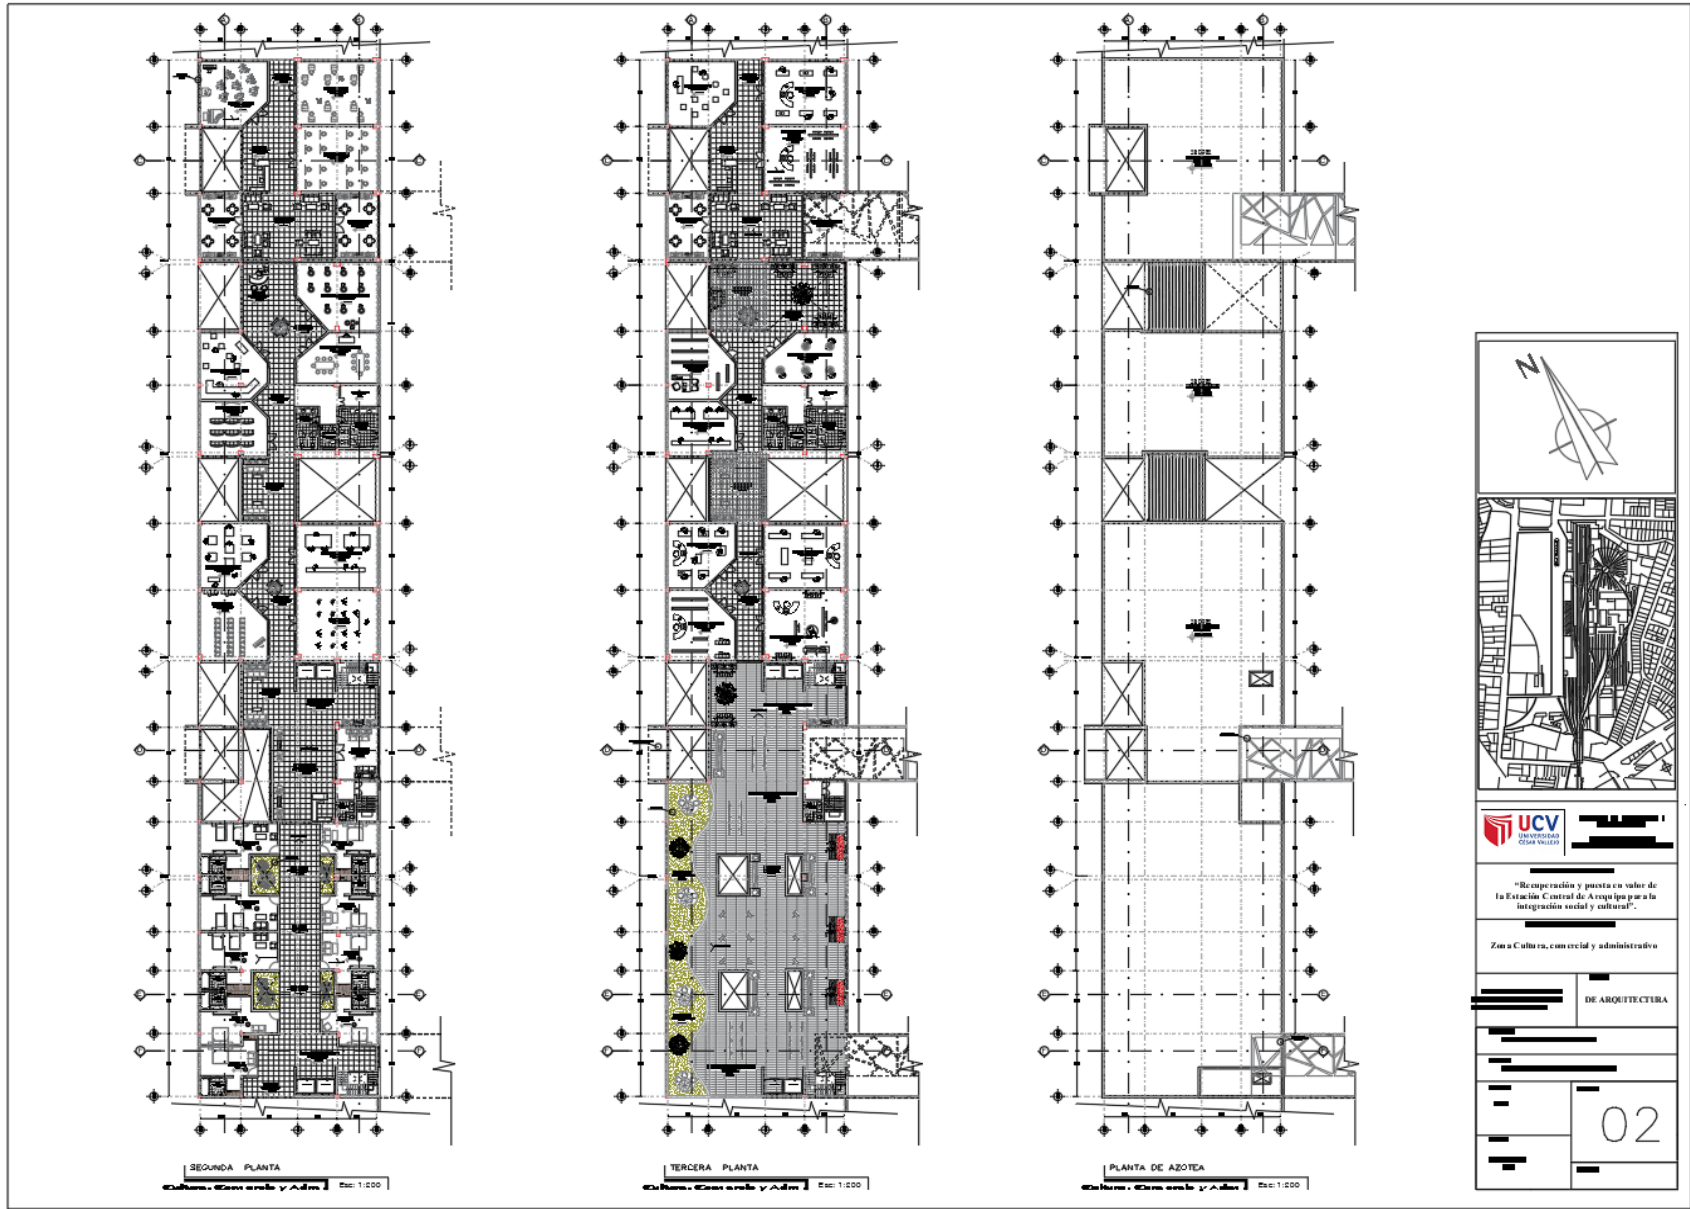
Plano de Distribución Arquitectónica- SEGUNDO, TERCER NIVEL Y PLANTA DE TECHO
